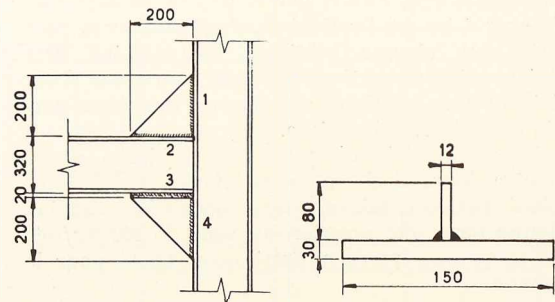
Assemblage des poutres aux cordons extérieurs. Fig. 11. Raidissement d'un plat par une nervure verticale.
